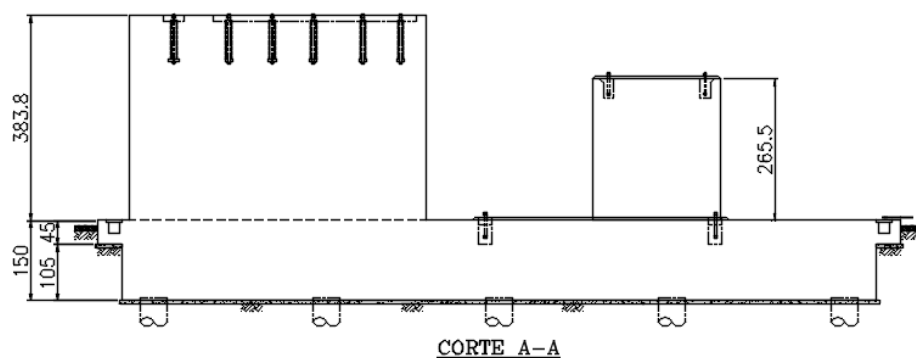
Modelo estrutural: elevação da fundação (Corte A-A)
